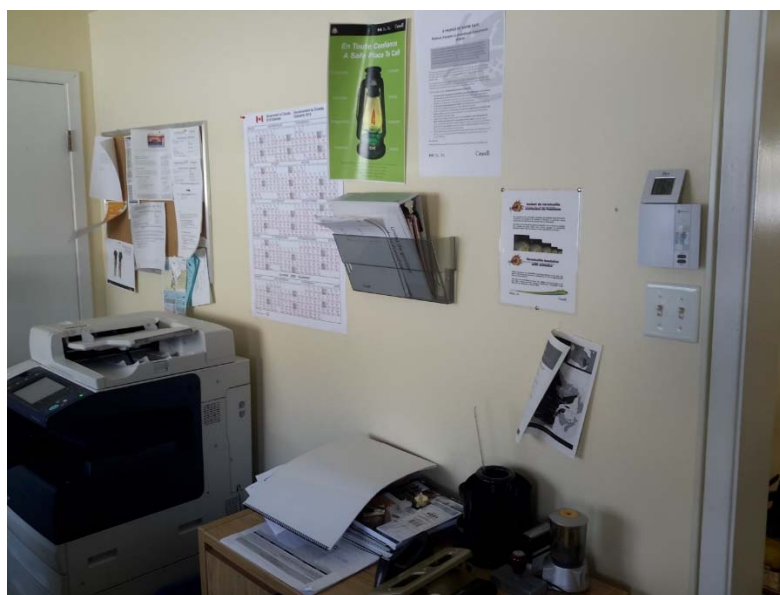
Le ciment à joint de mur de placoplâtre contient de l'amiante
